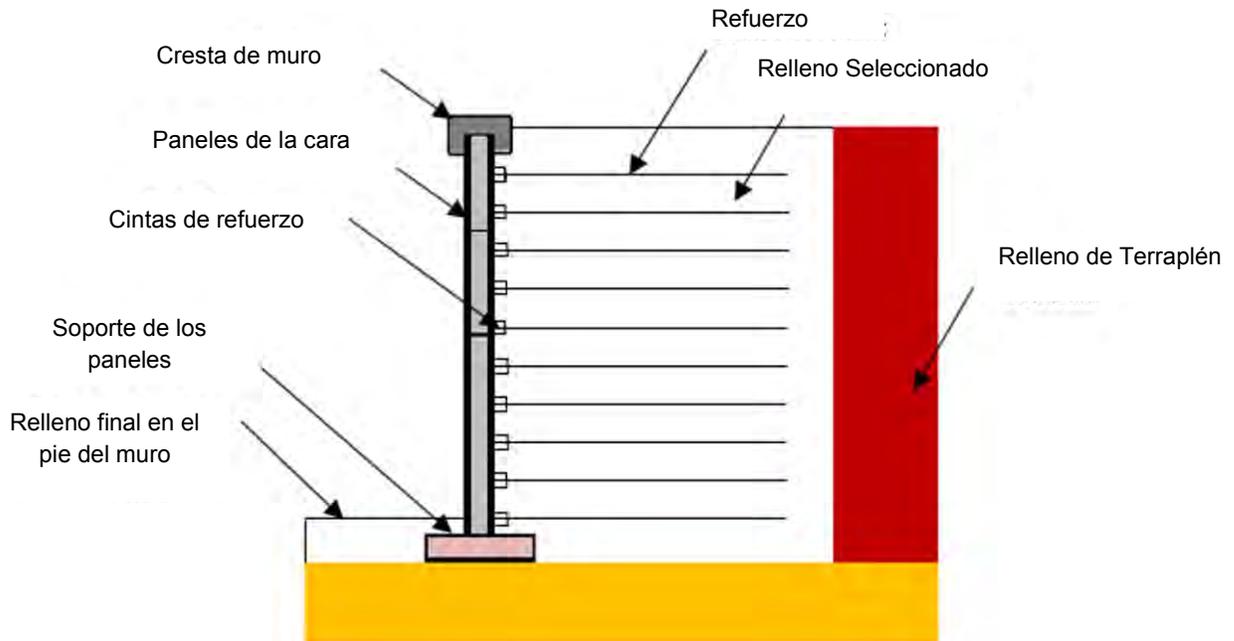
1: Componentes de Muro de Suelo Reforzado Fuente (Tarawneh, 2018)
